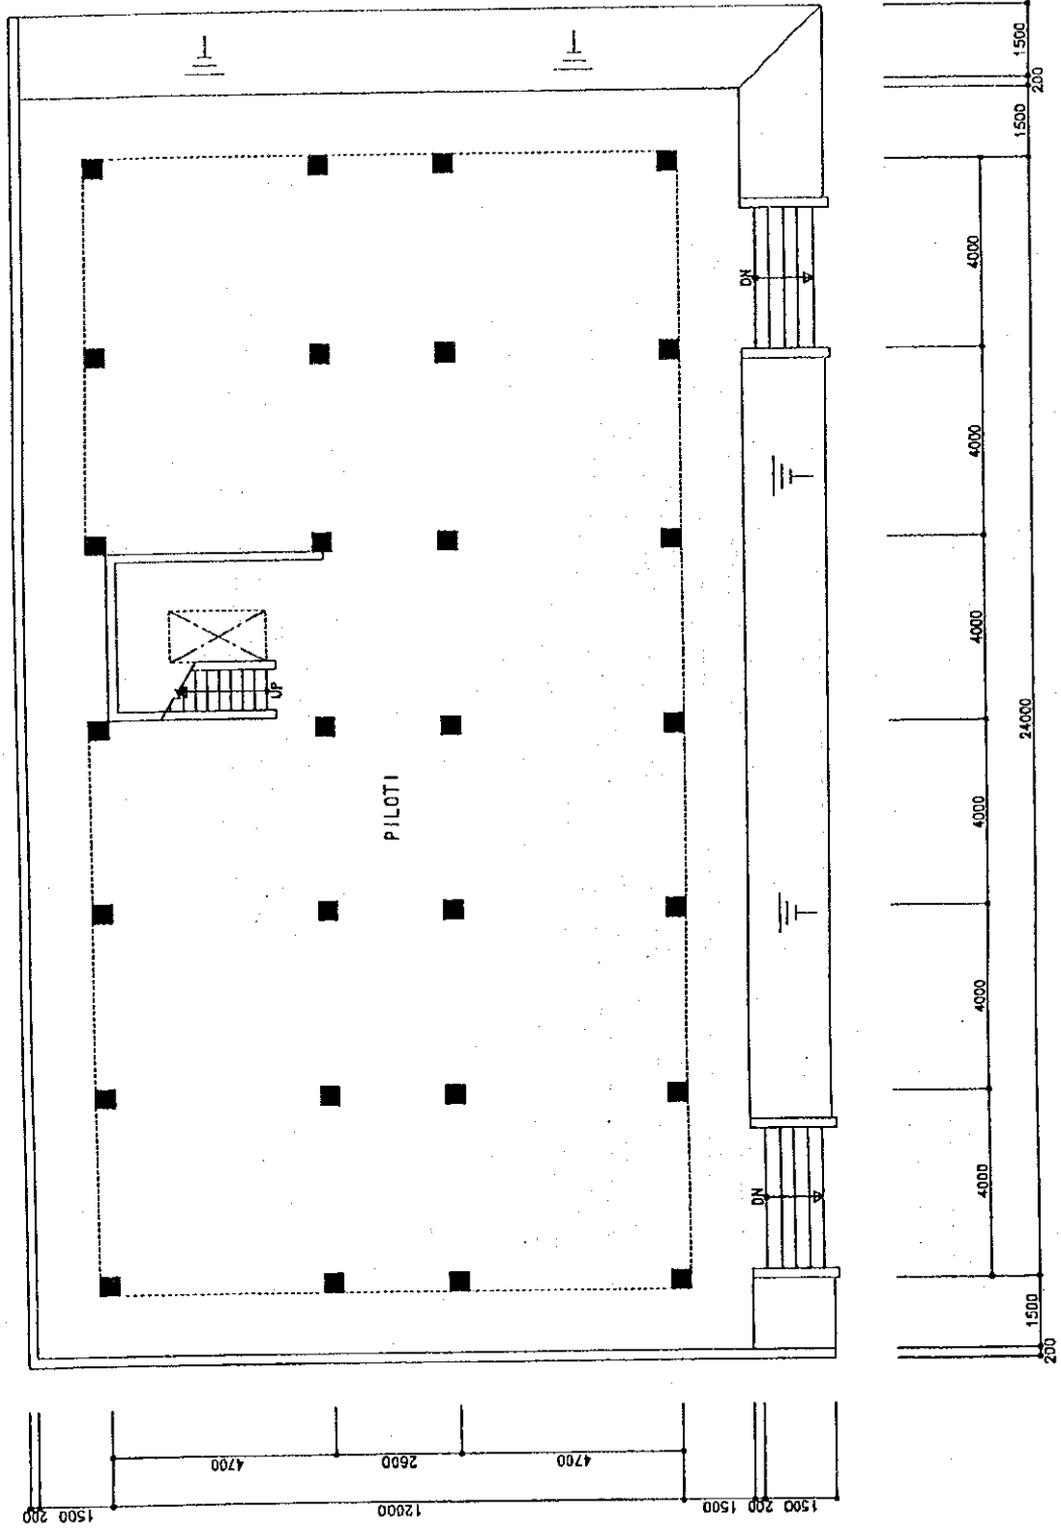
(1) 1 階平面図 (4 教室タイプ)
